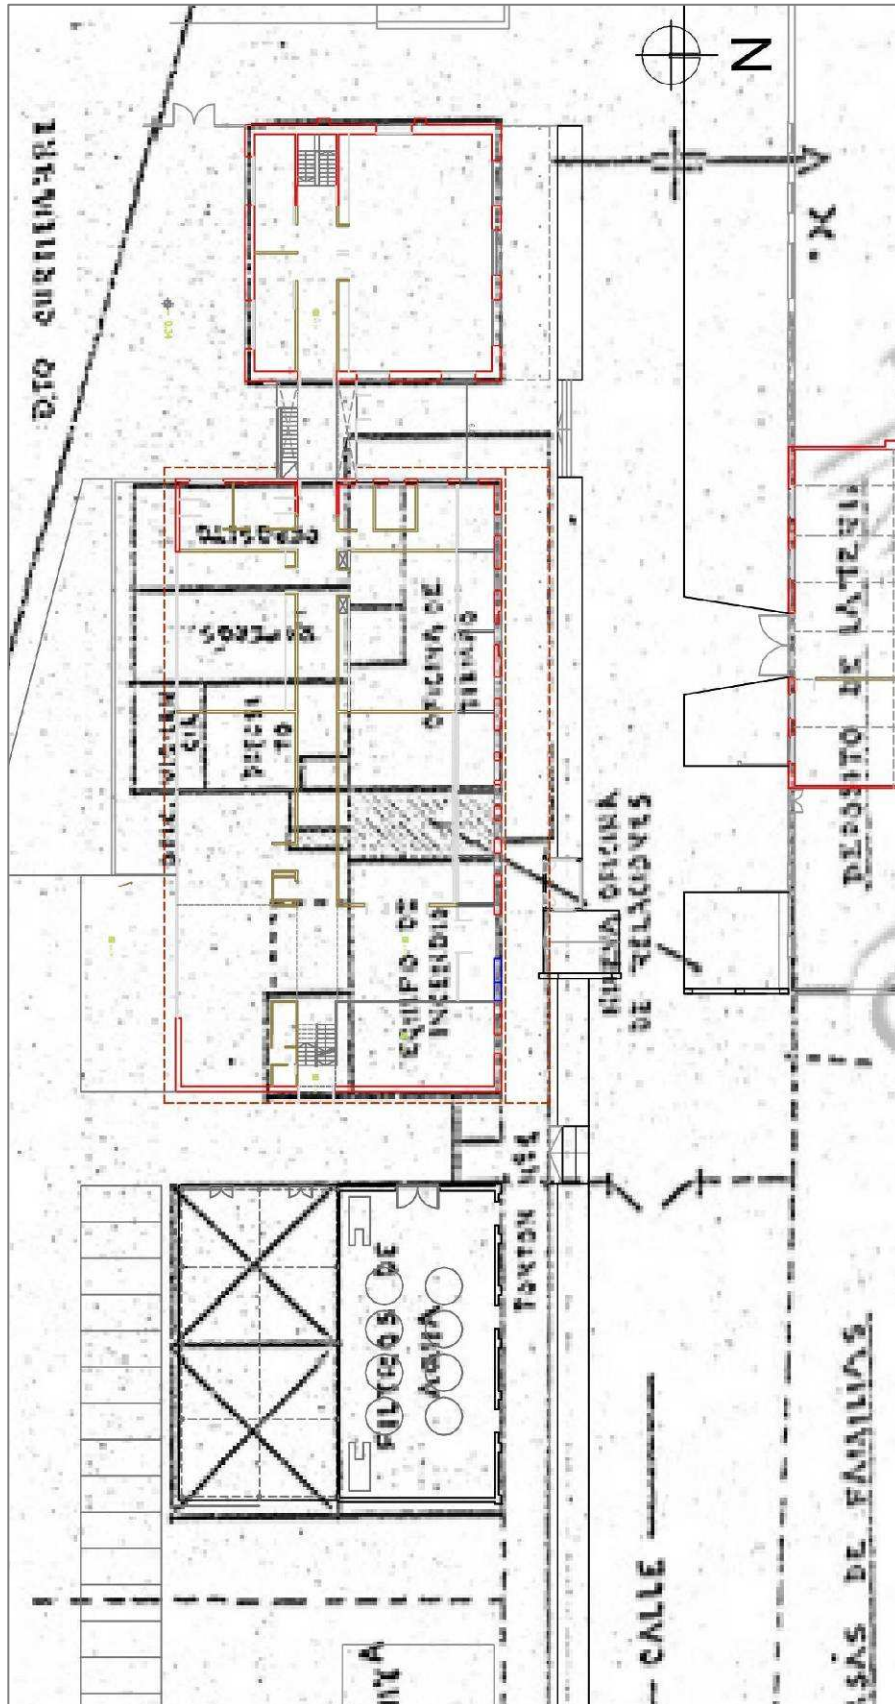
Detalle de plano histórico (078) con superposición de Layout de obra.
